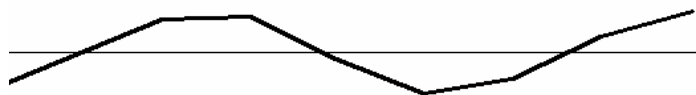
Схема синусоидальной укладки трубопровода
